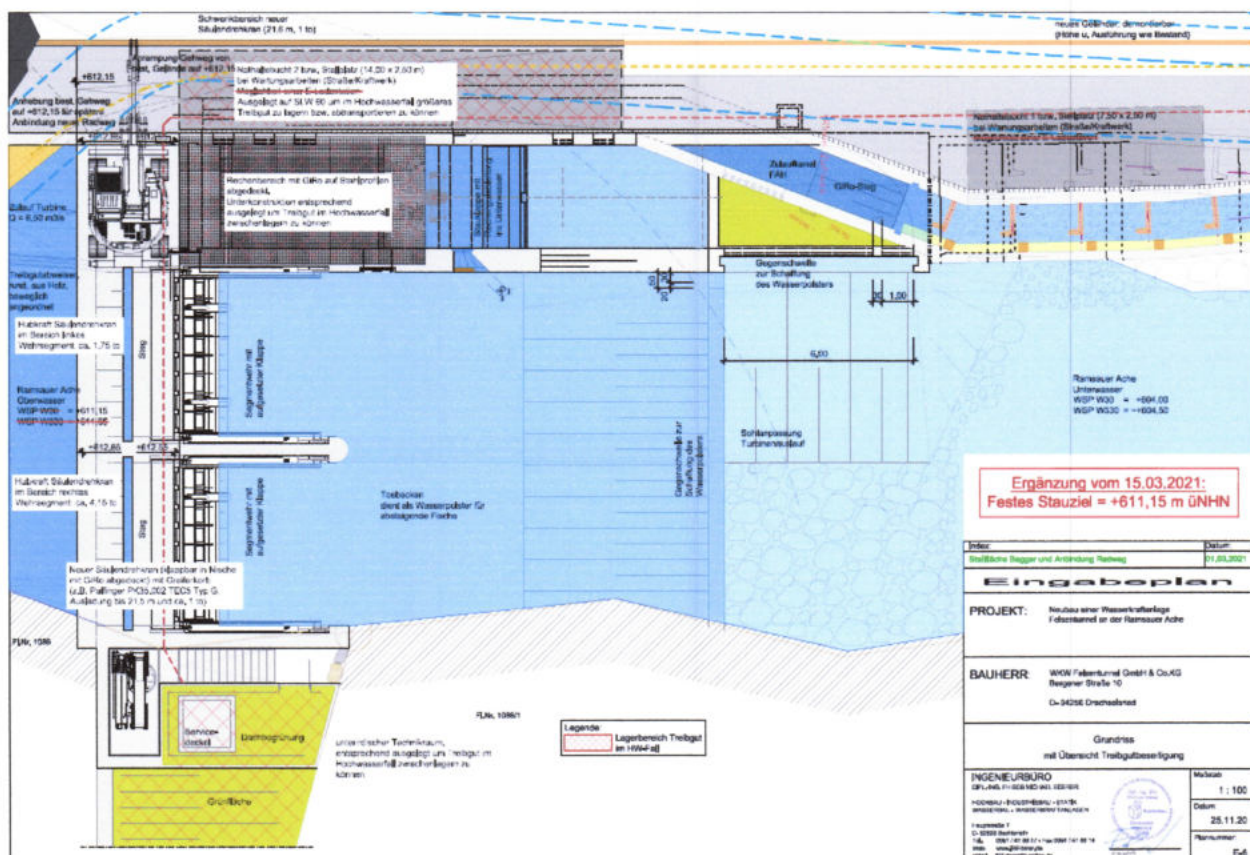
Übersichtslageplan der Wasserkraftanlage (IB Ederer Planungsstand mit Index 01.03.2021 - Ergänzung 15.03.2021).
